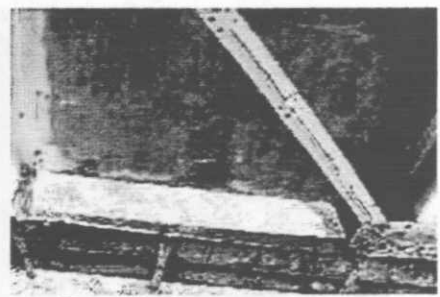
Fisuras reticulares y eflorescencias, corrosión del acero. Drenes tapados por sobrecarpeta. Puente Quebrada Anchique (Huila).
